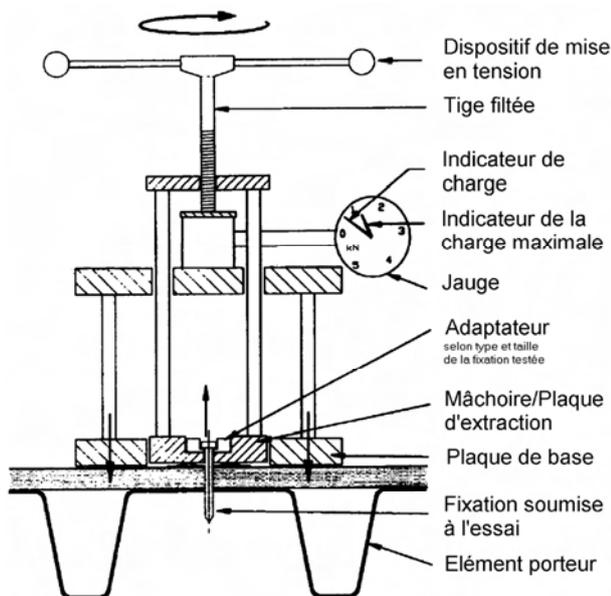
Principe d'un essai d'arrachement sur chantier (exemple de la maçonnerie : poutres + dalle béton armé)
